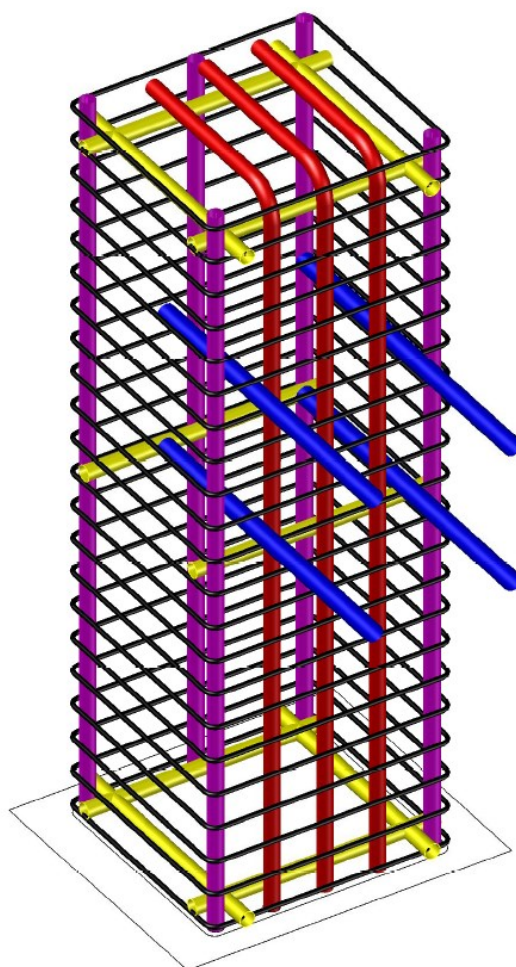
Vista 3D da disposição das armaduras do bloco de concreto.
